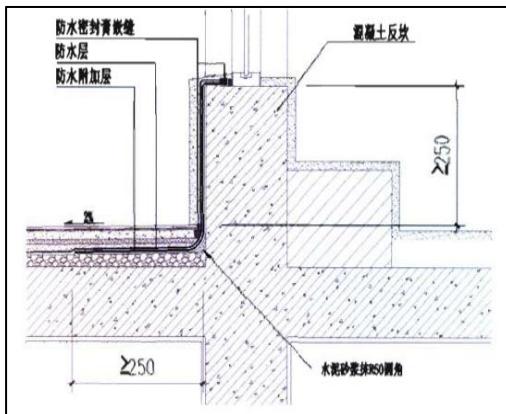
屋面女儿墙反坎防水节点示意图
